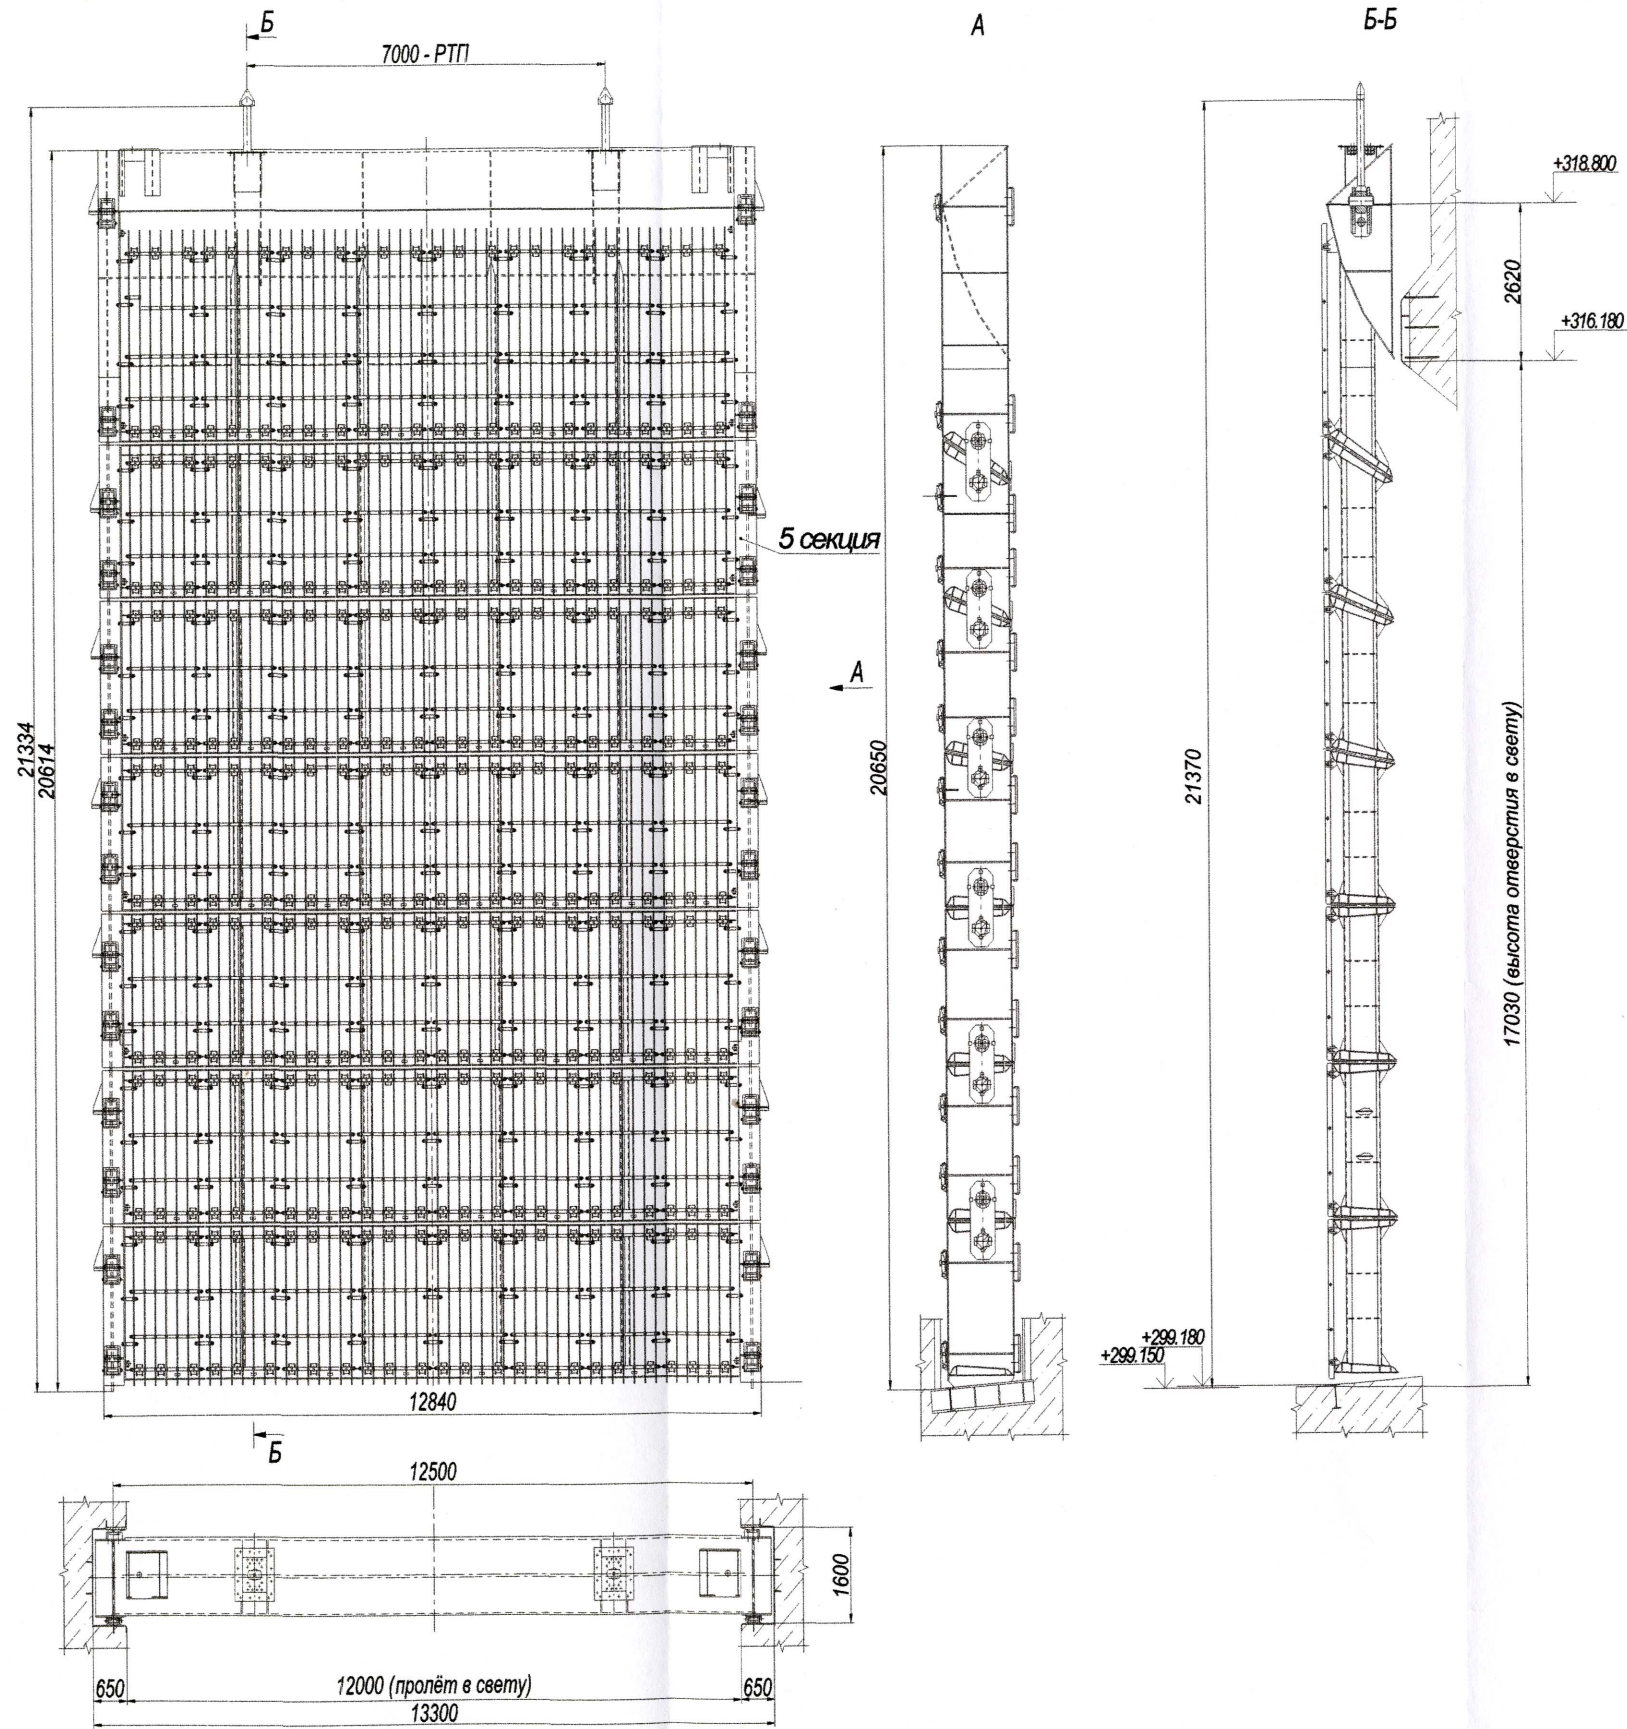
Схема металлоконструкции сороудерживающей решетки
